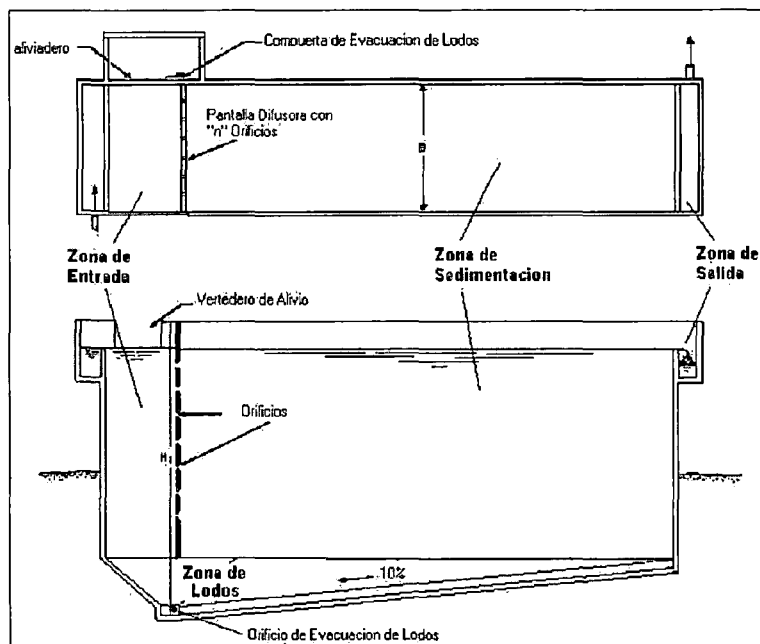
Sedimentador (Planta y Corte Longitudinal).
